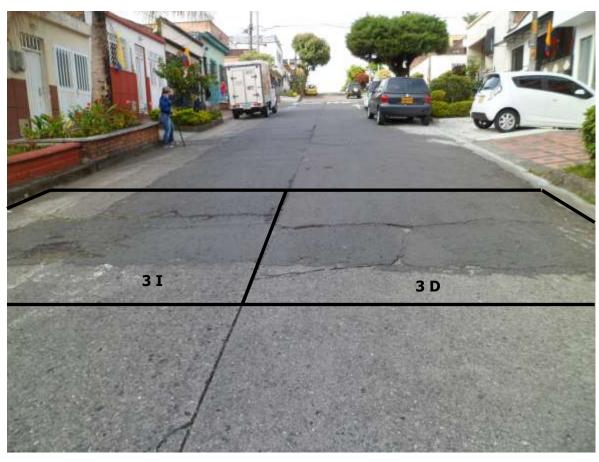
Tramo vehicular C 2 (Cl 24 entre Cra 19 y Cra 19 Bis) pavimento rígido.
